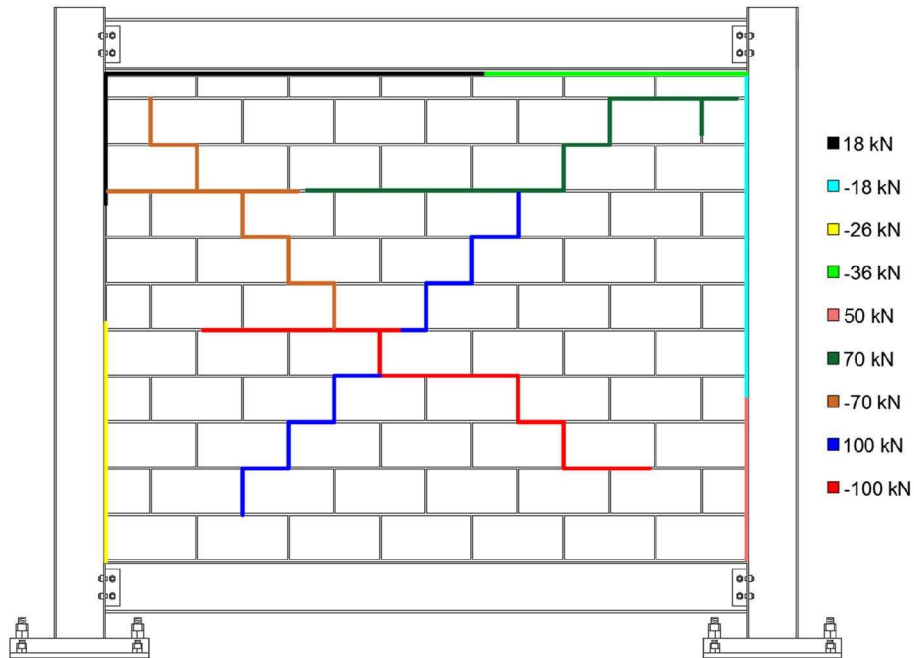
Fissuras - Ensaio PP-2-CE-0.5/2.0
